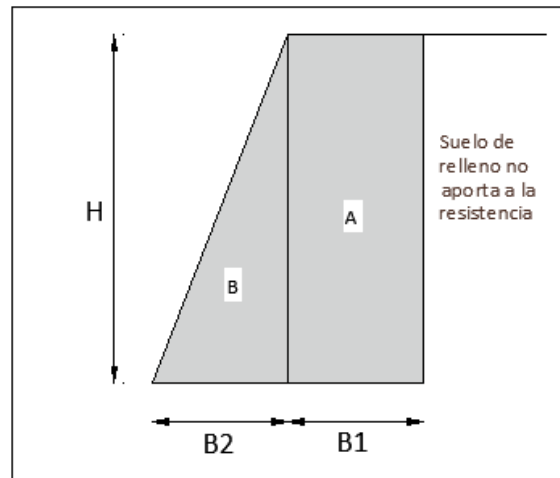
Partes del muro de gravedad con sección trapezoidal rectangular.
